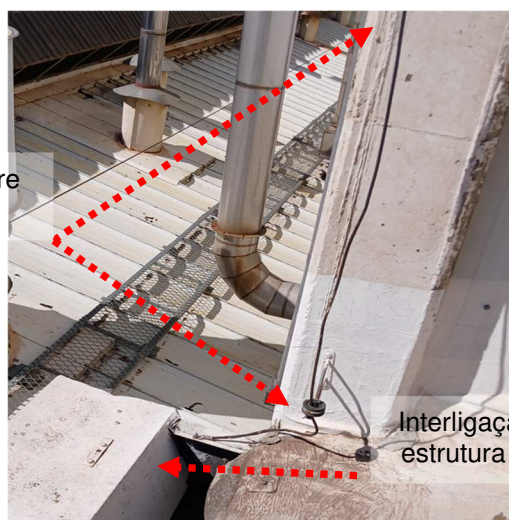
e 145: Malha captora construída em perfil de alumínio seção #70mm².
